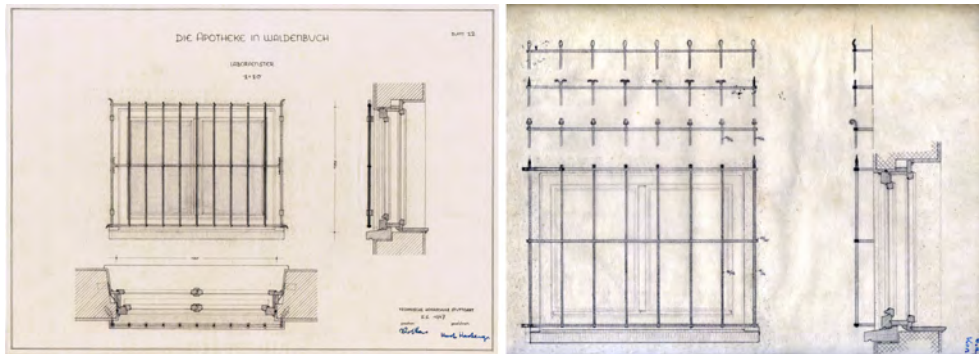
Zweiter Entwurf: „Apotheker in Waldenbuch“, Detail Laborfenster; Entwurfszeichnungen zum Fenstergitter
